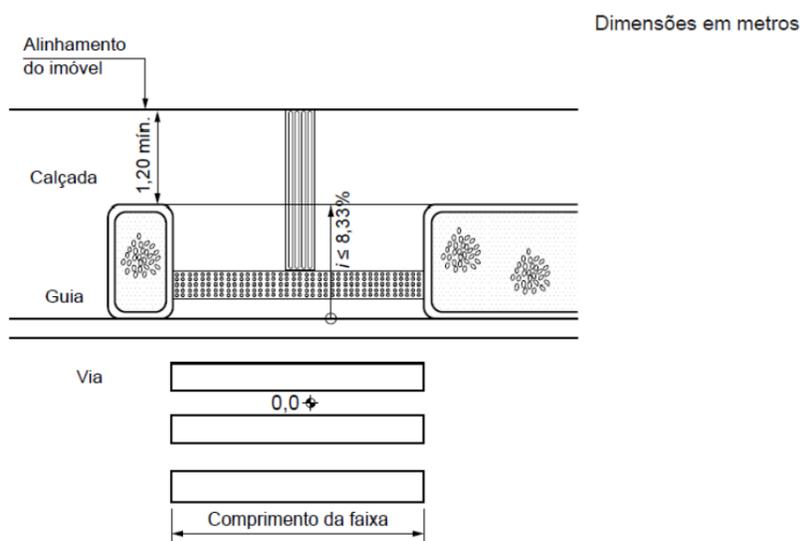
| Rebaixamento de calçada entre canteiros: Vista Superior
